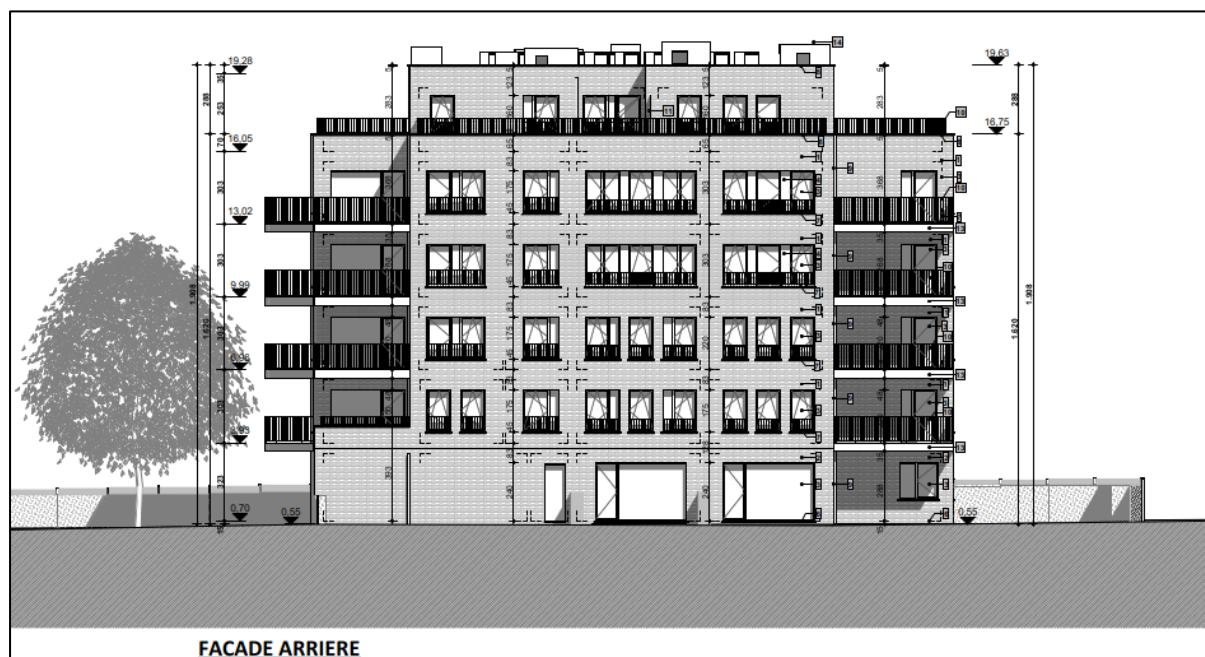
Façade arrière du bâtiment 2 (source : Plans PU)
